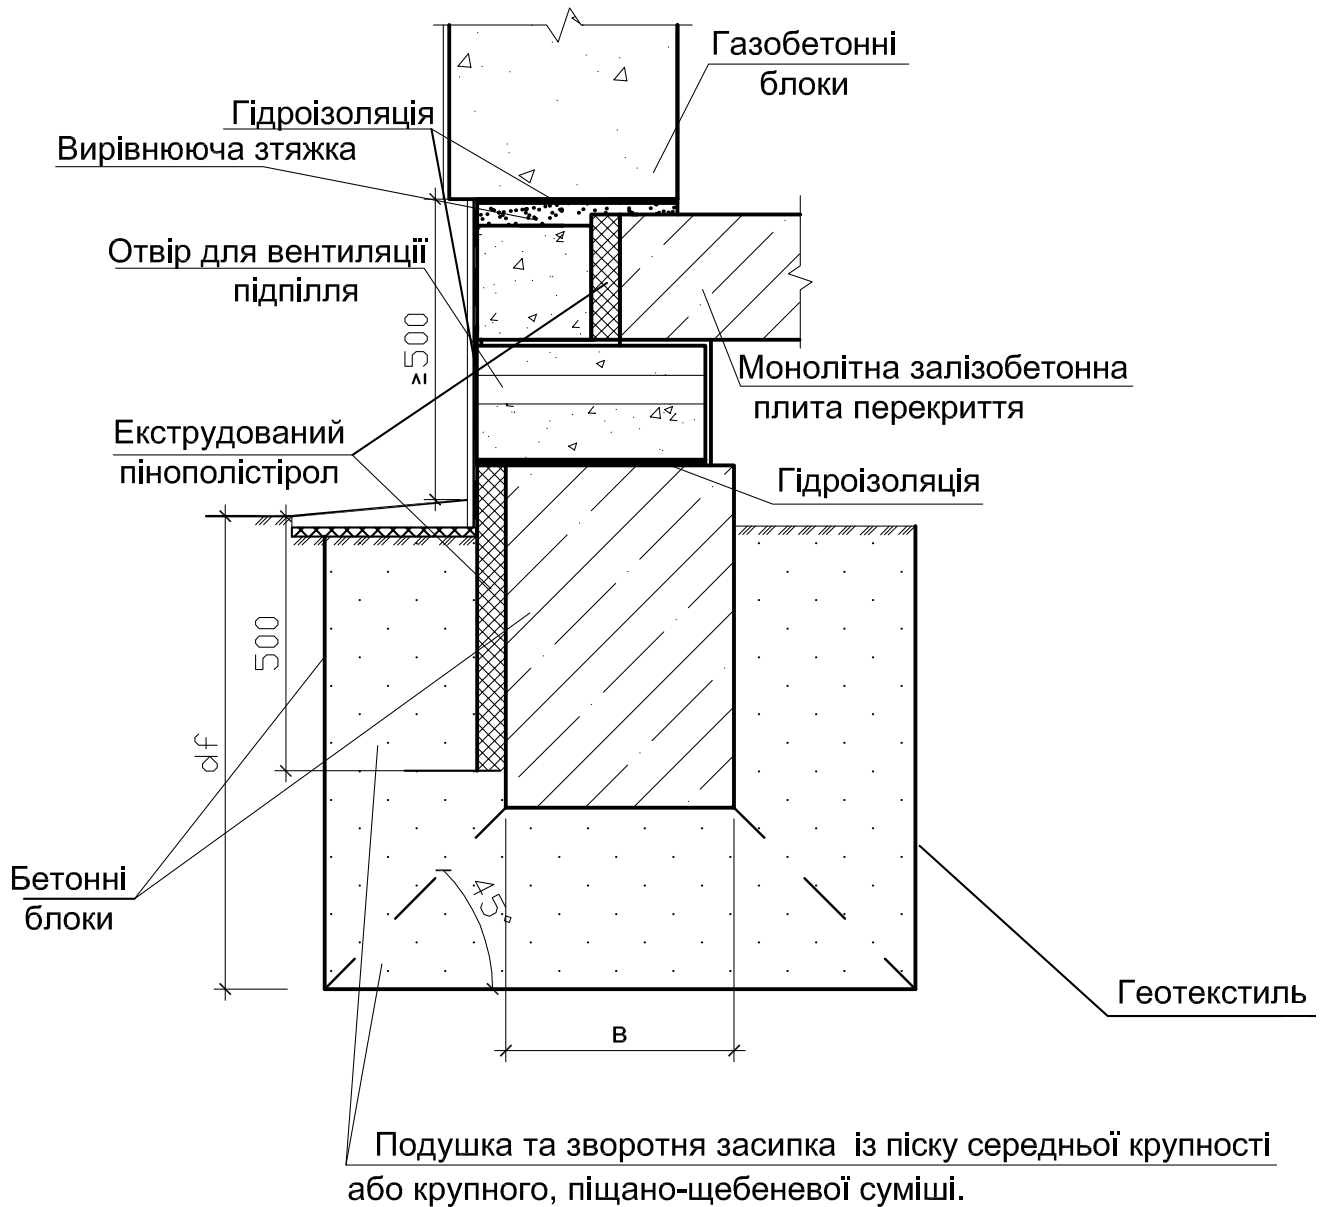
2-11. Влаштування цоколя з U-блоком для варіанту з монолітним залізобетонним перекриттям
